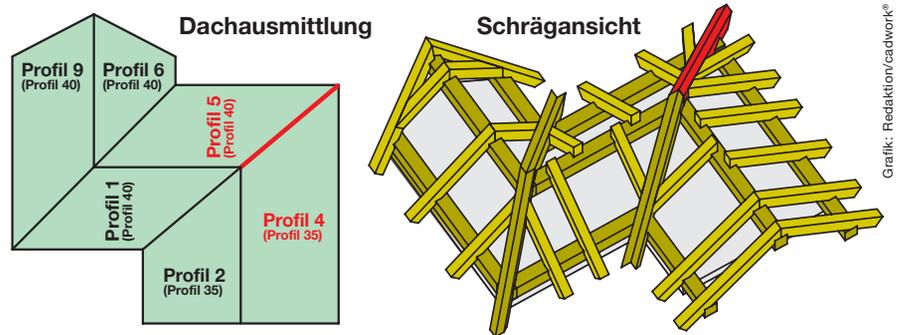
Dachausmittlung und Schrägansicht des Modells mit dem bearbeiteten Gratsparren (rot angelegt)
